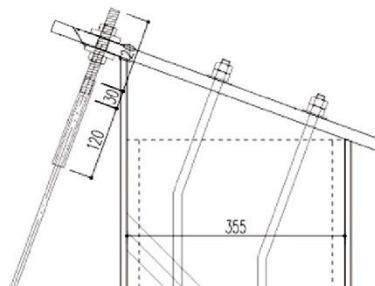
Detalle de los anclajes a nivel de cubierta mediante piezas metálicas
